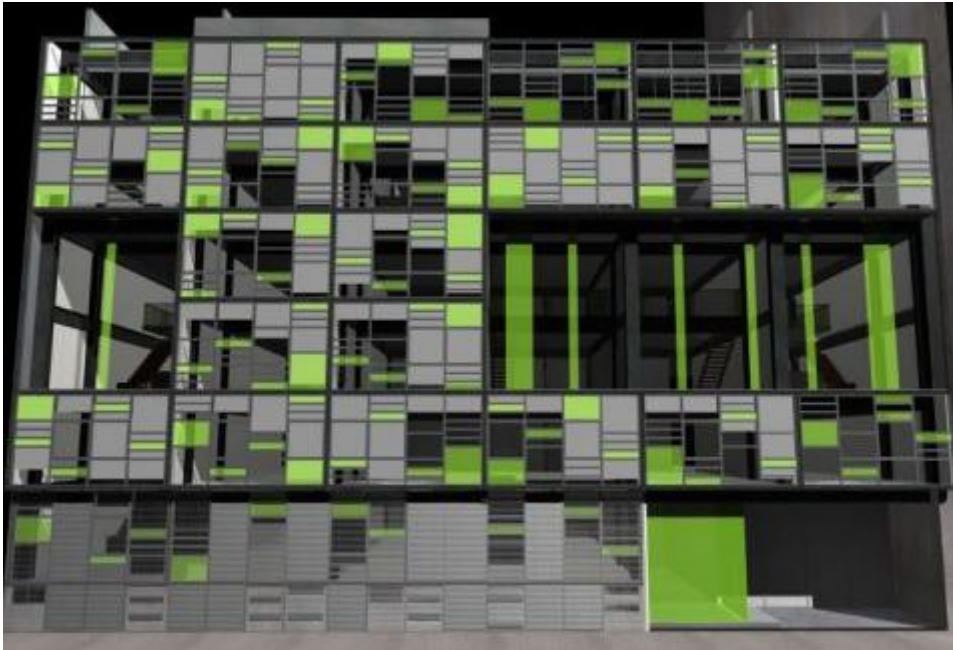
Edificio Amsterdam. Fachada principal. Fuente: Taller 13.
